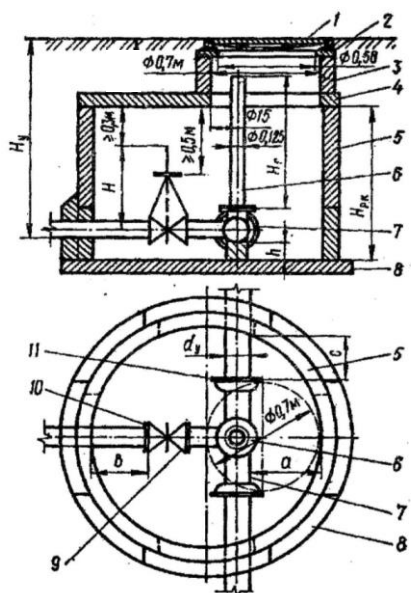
Схема водопровідного колодязя із круглих залізобетонних елементів:
